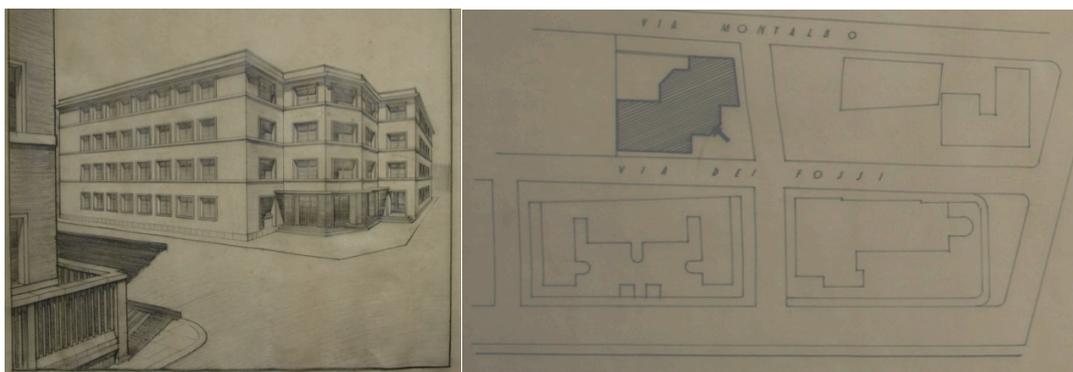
Cantieri Navali Riuniti, Palermo, Progetto di edificio ad uso spogliatoio operai, s.d., ASAn, fondo Luchetti
